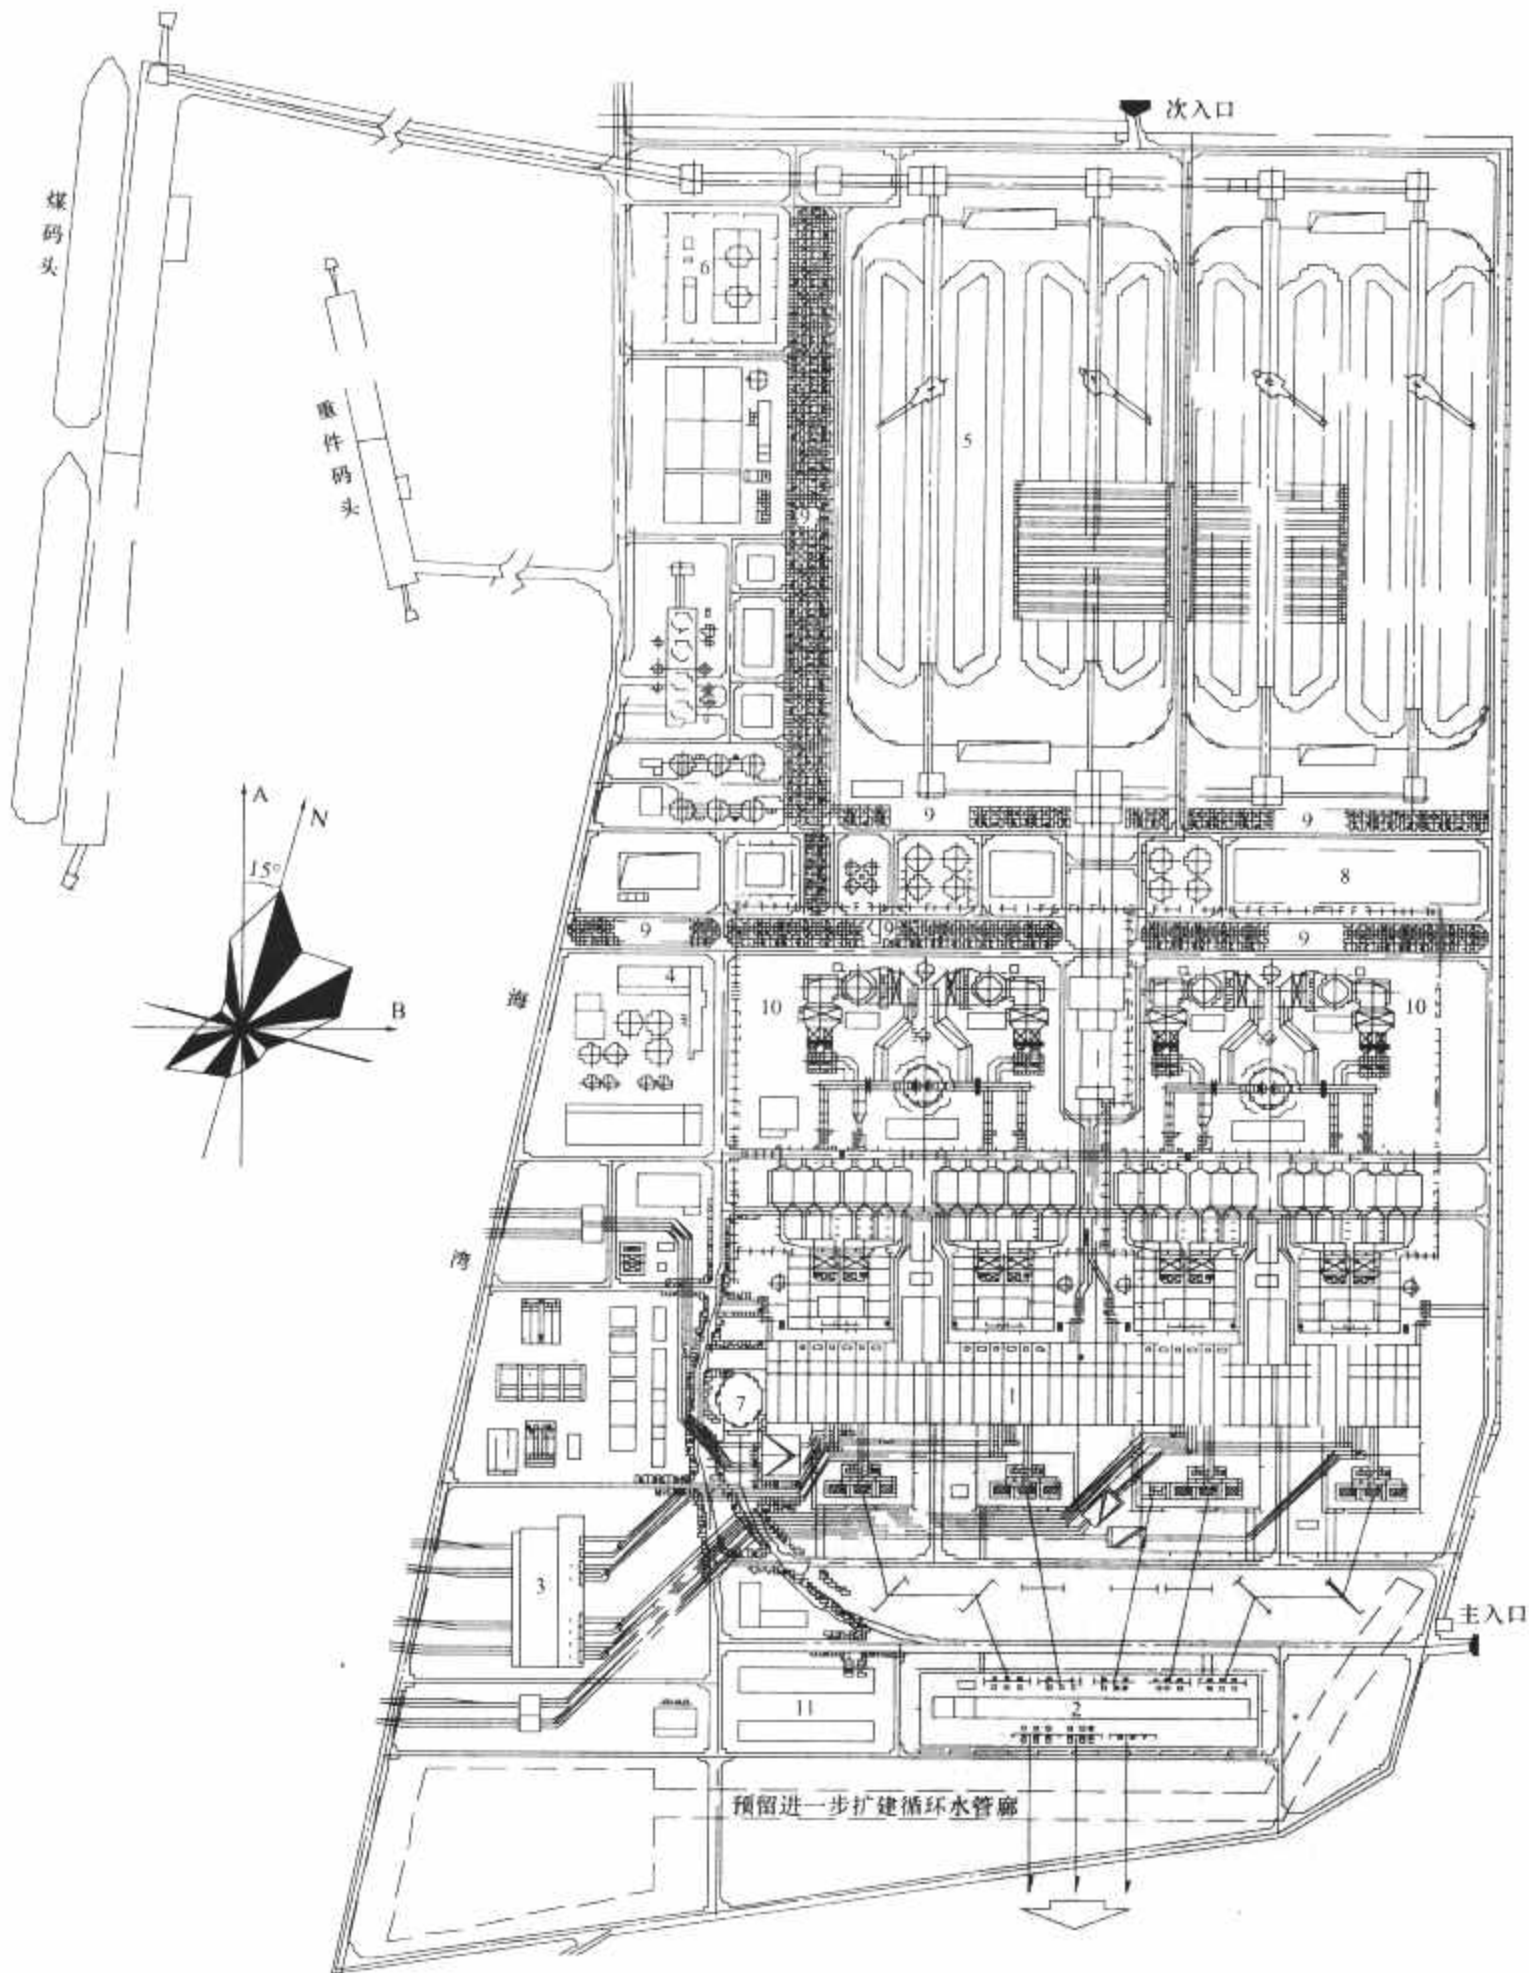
主厂房固定端朝向水源的三列式电厂总平面布置图
